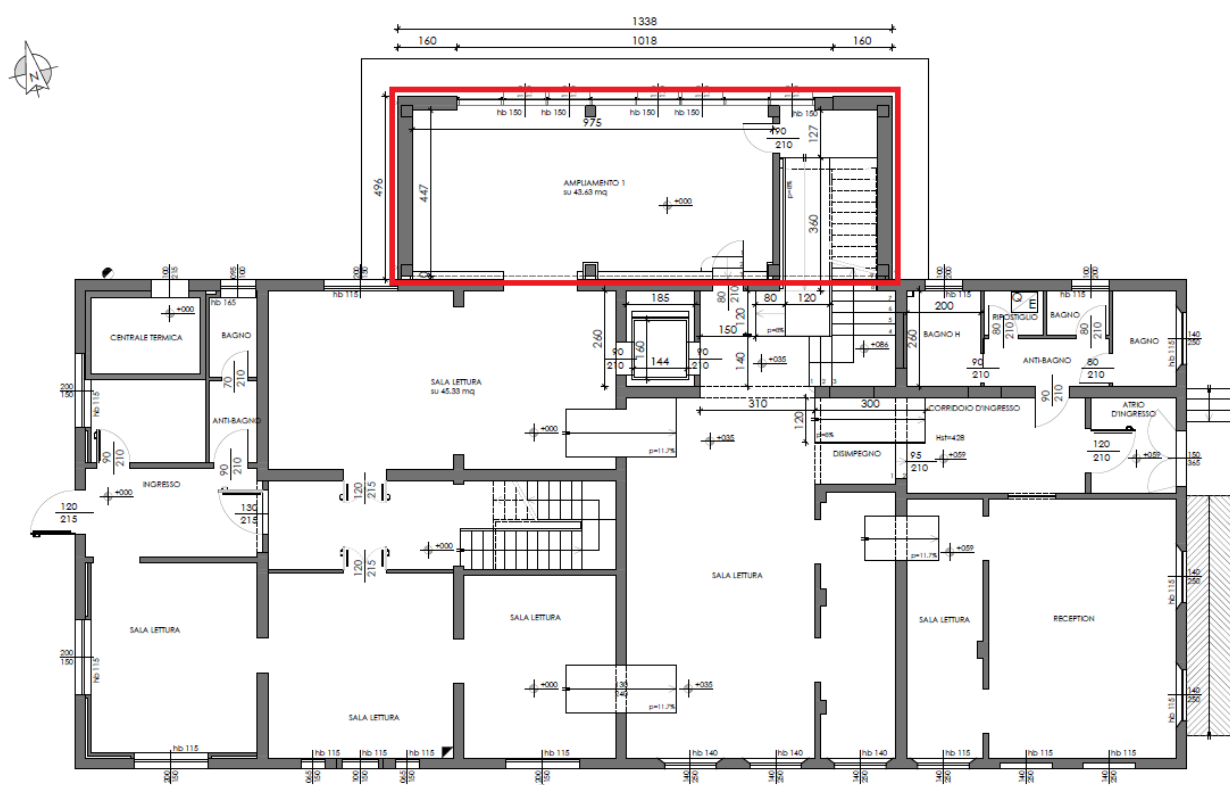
Planimetria generale dell'intervento – Individuazione ampliamento
